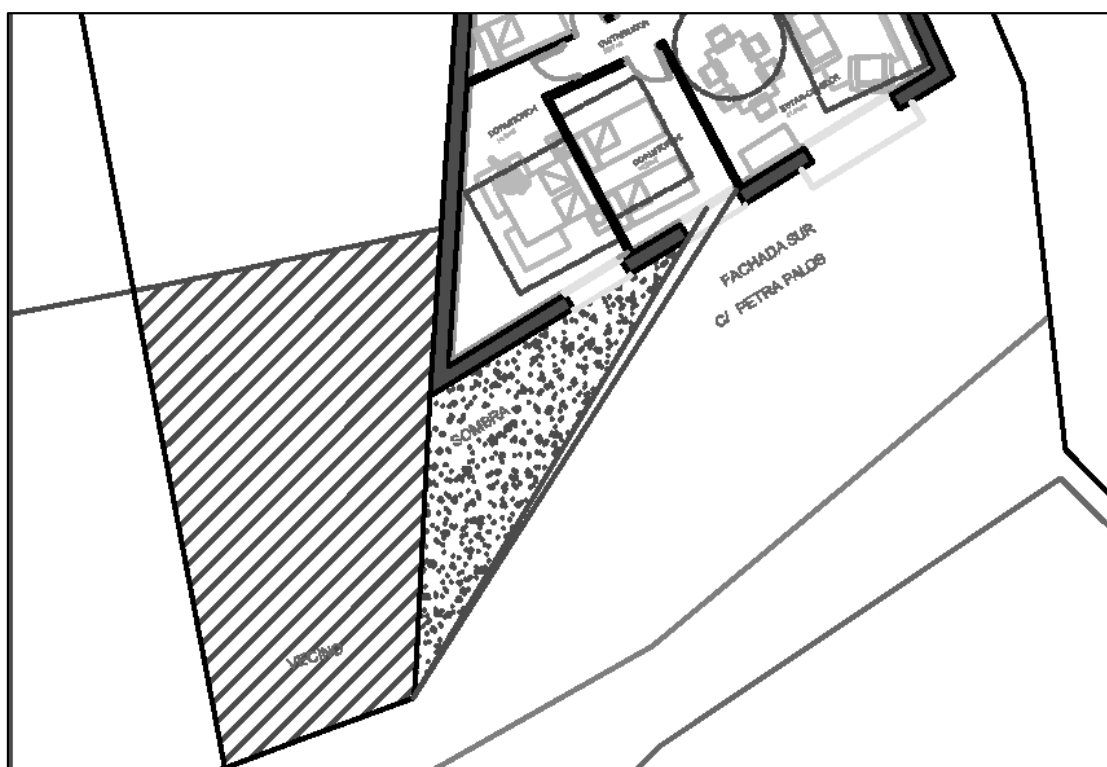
Proyección de la sombra sobre la fachada, hueco central.
